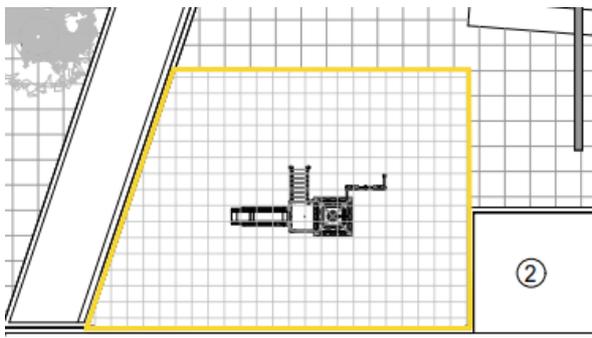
Planta da situação existente (PI 2) | Fonte: autora, 2023 | sem escala
